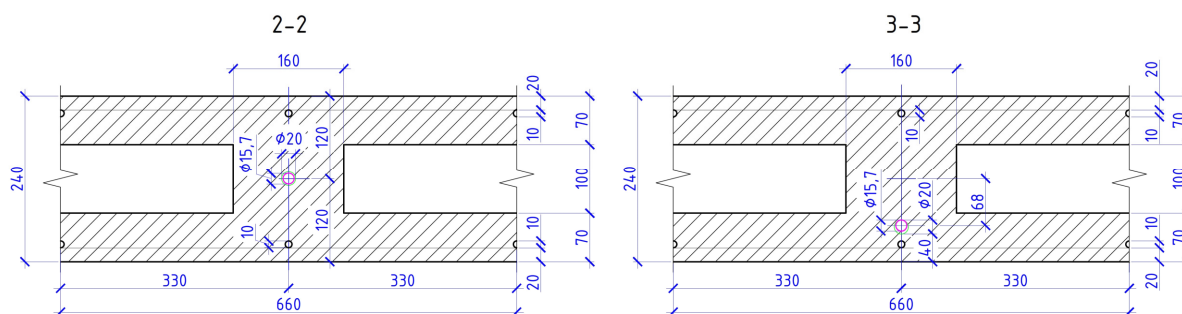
Разрезы 2-го варианта перекрытия поперек монострендов
